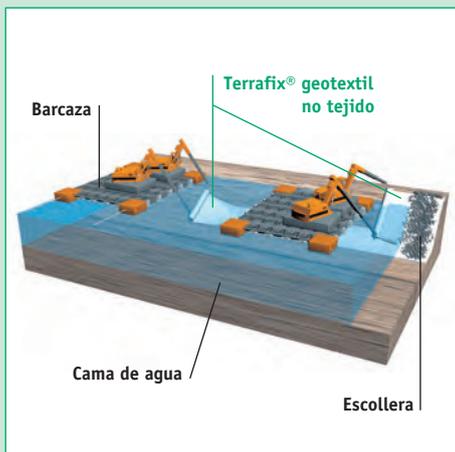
Aplicación estándar de filtros de geotextiles no tejidos Terrafix® en la pendiente y lecho del río o canal.
